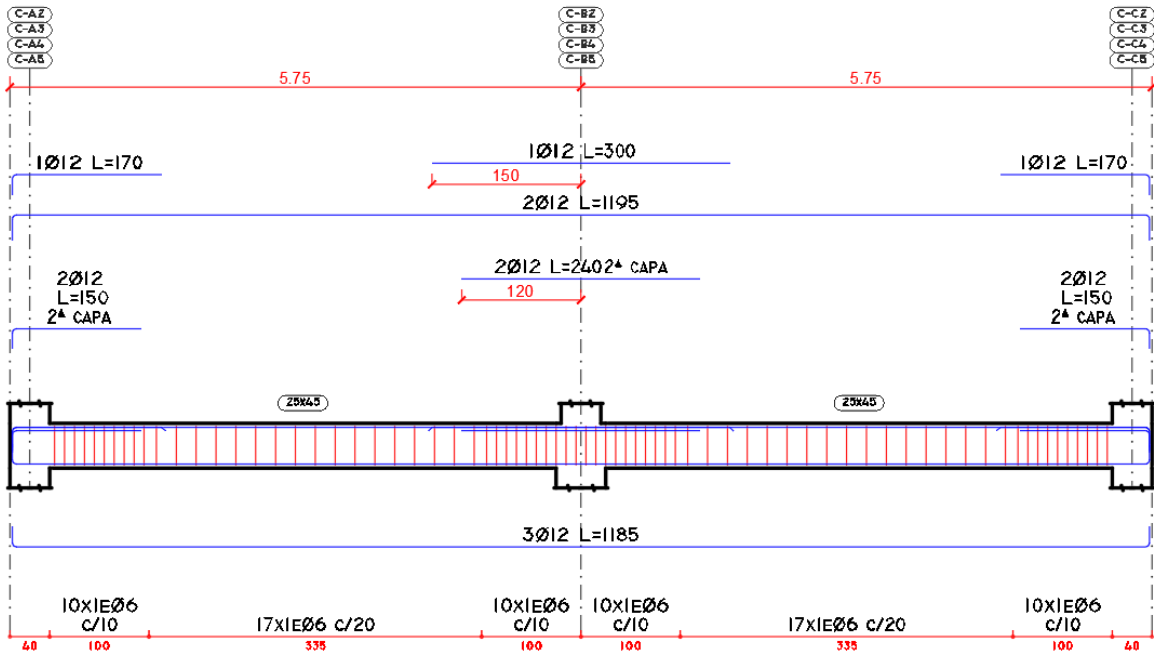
Detalle de Refuerzo Vigas en "X" Estructura [7N-SS].
